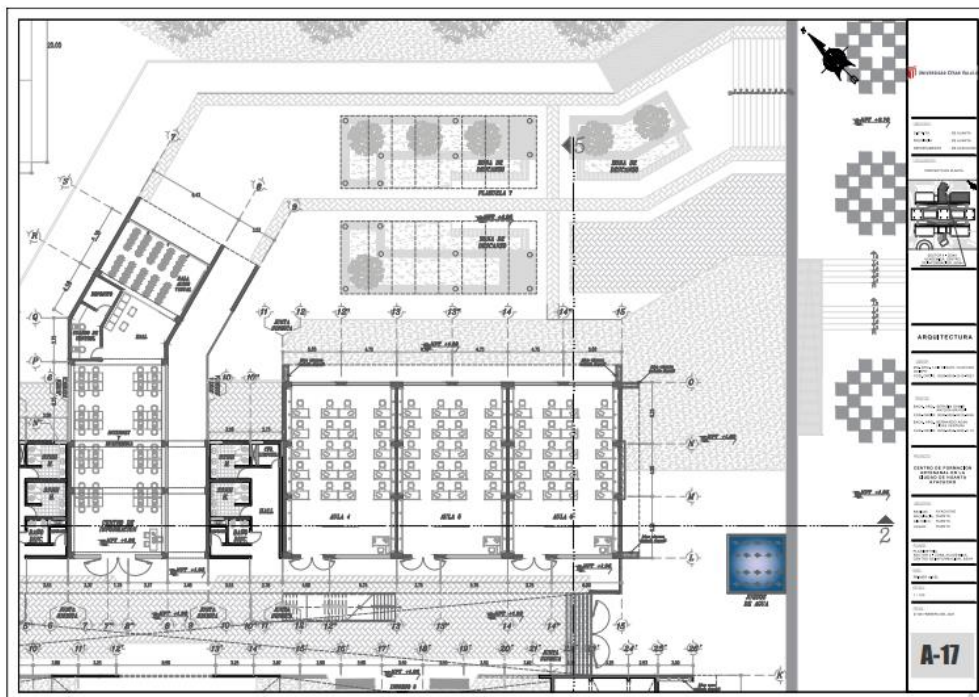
Planimetría del sector 4 ubicado en el piso 1. Escala 1/100.
